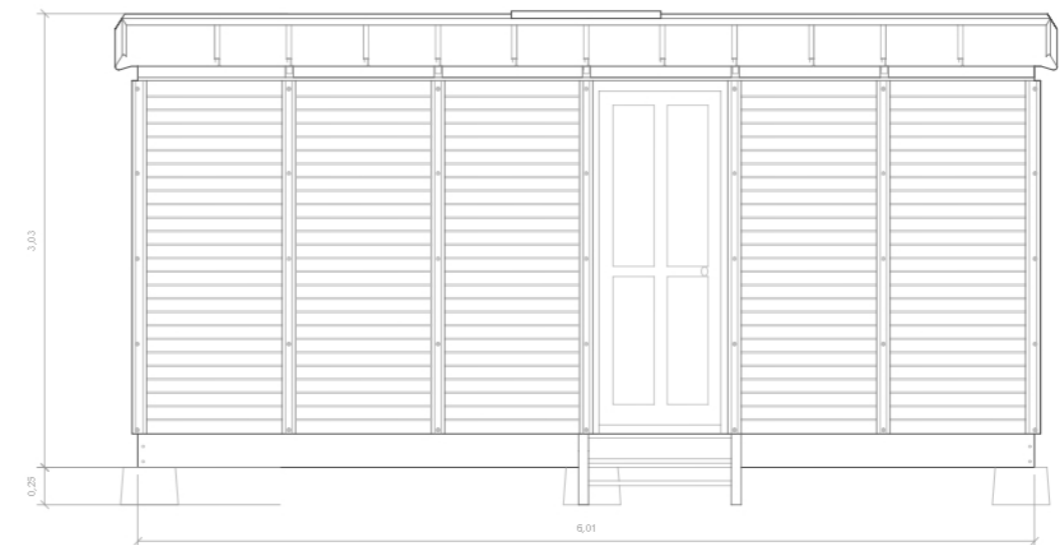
Alzados vivienda desmontable 6x6. E:1/50. Elaboración propia.
